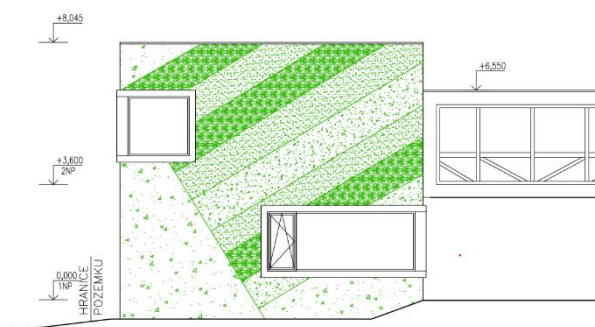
Pohled na dřevěný obklad jižní fasády, zdroj autor
